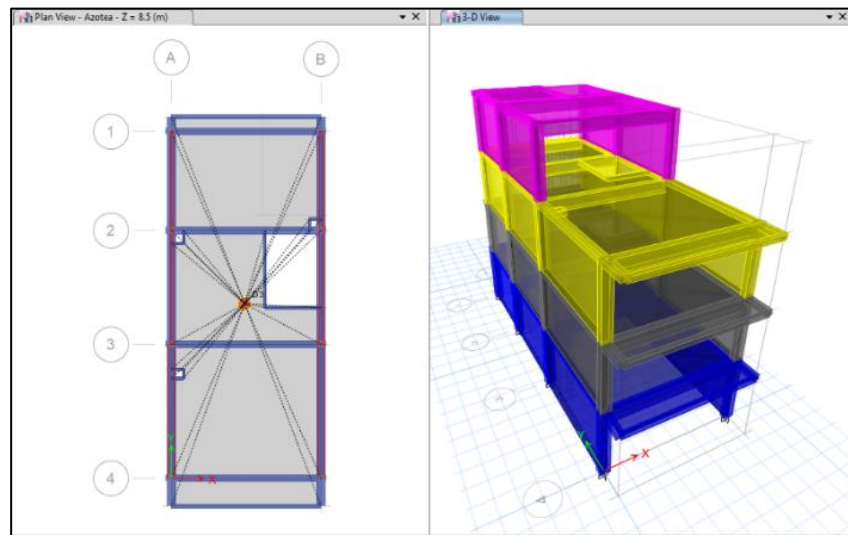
ETABS - Vista en Planta (Izquierda) y Vista 3D (Derecha) de la Vivienda Informal CH-1.
